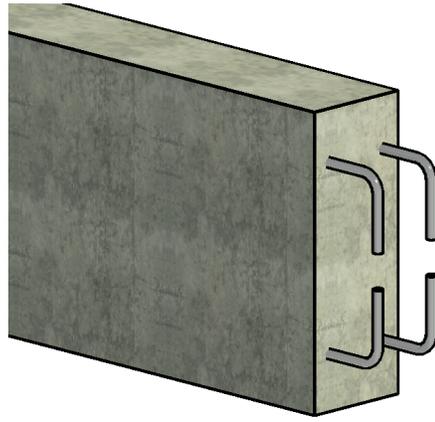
Aceros longitudinales de vigas. Fuente: Elaboración propia.
